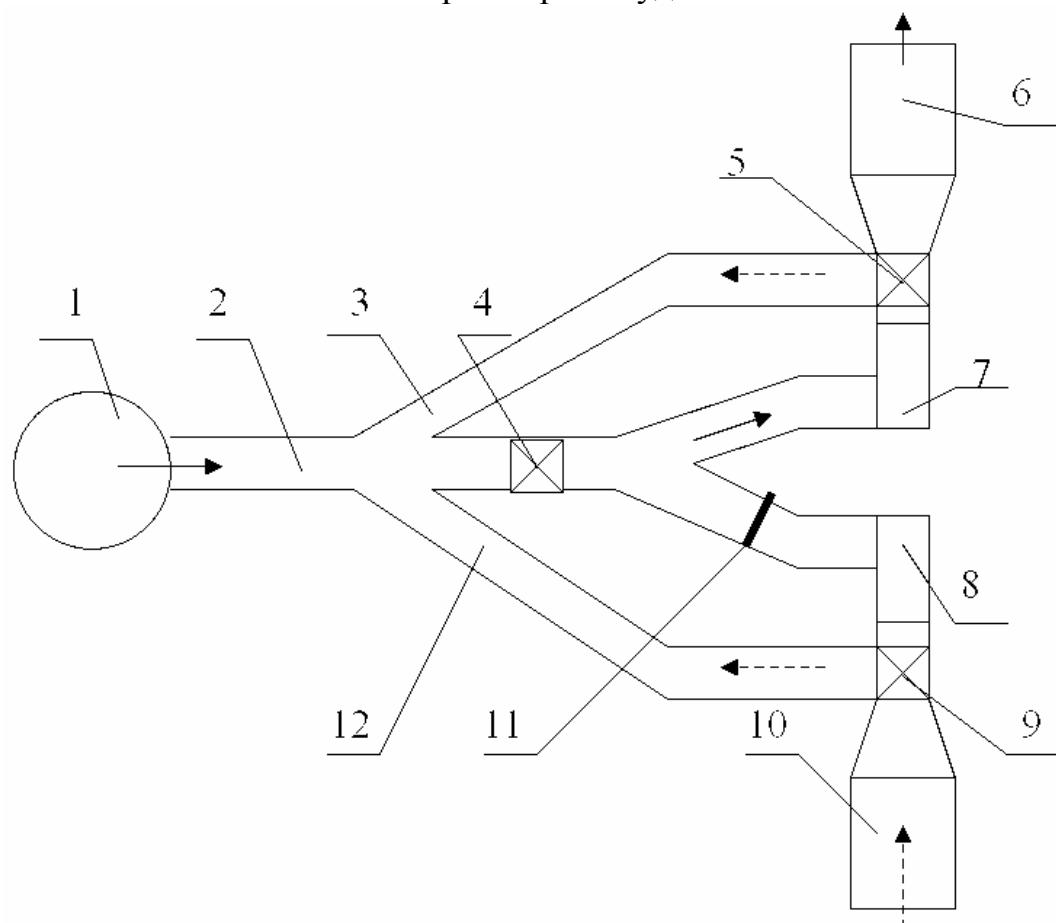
Схема вентиляторної установки з відцентровими вентиляторами
